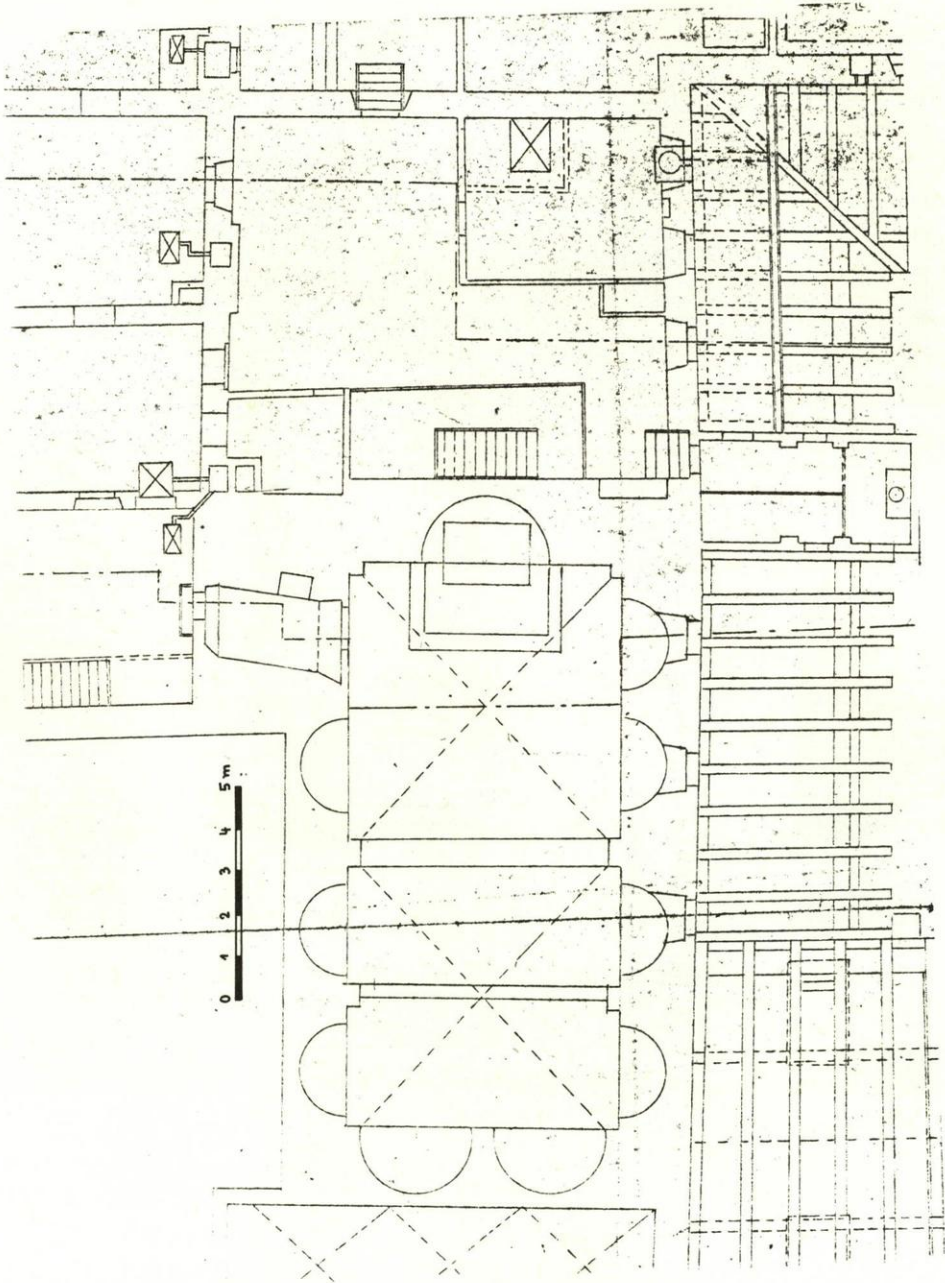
Grundriß des Quadermauerhauses im 2. Stock (Plan aus der Abteilung „Domkreuzgang“ im Landbauamt, datiert 1860).
